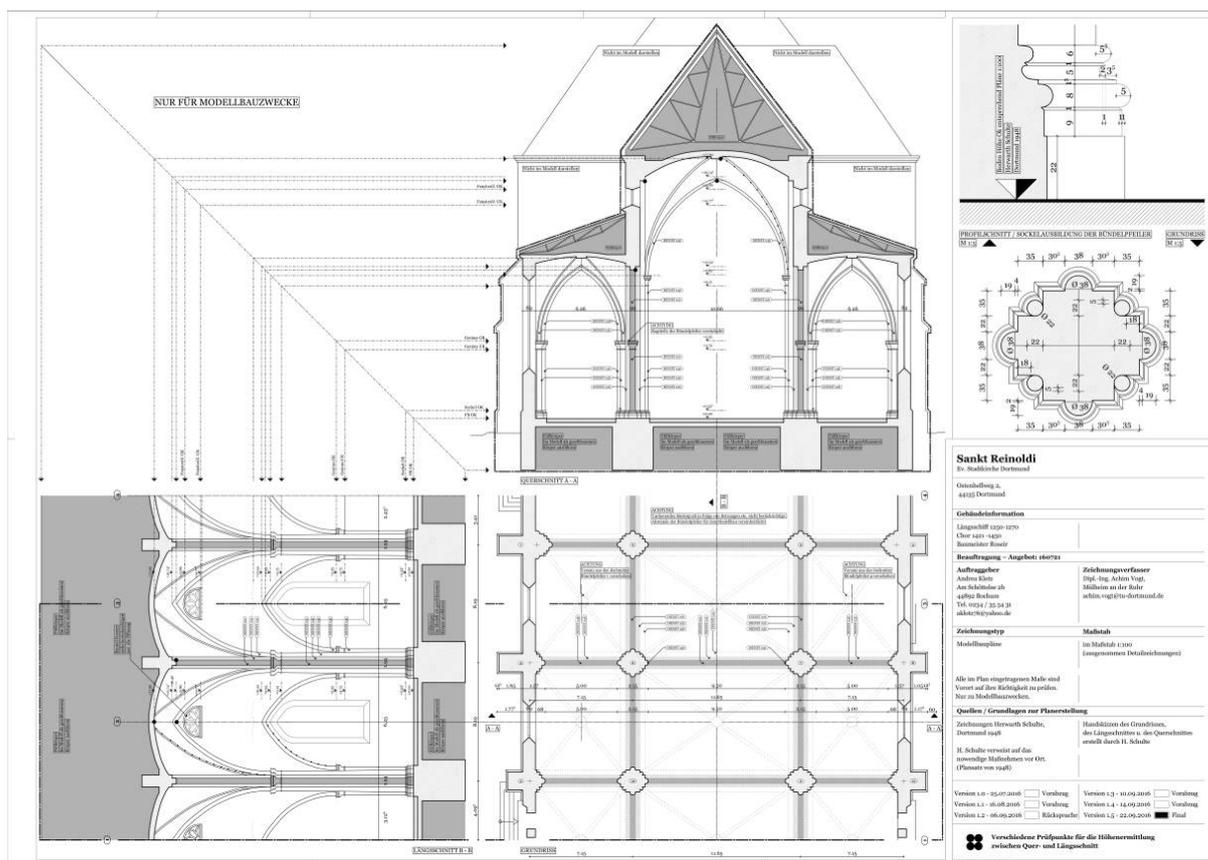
Digitaler Plan für Detailmodell *Querschnitt Langhaus-Joch*: Längs- sowie Querschnitt mit entsprechendem Grundrissausschnitt, Maßstab 1:100 (ausgenommen Detailzeichnungen), erstellt durch Achim Vogt, PDF-Datei (84,1 x 59,4 cm). (© ak)
